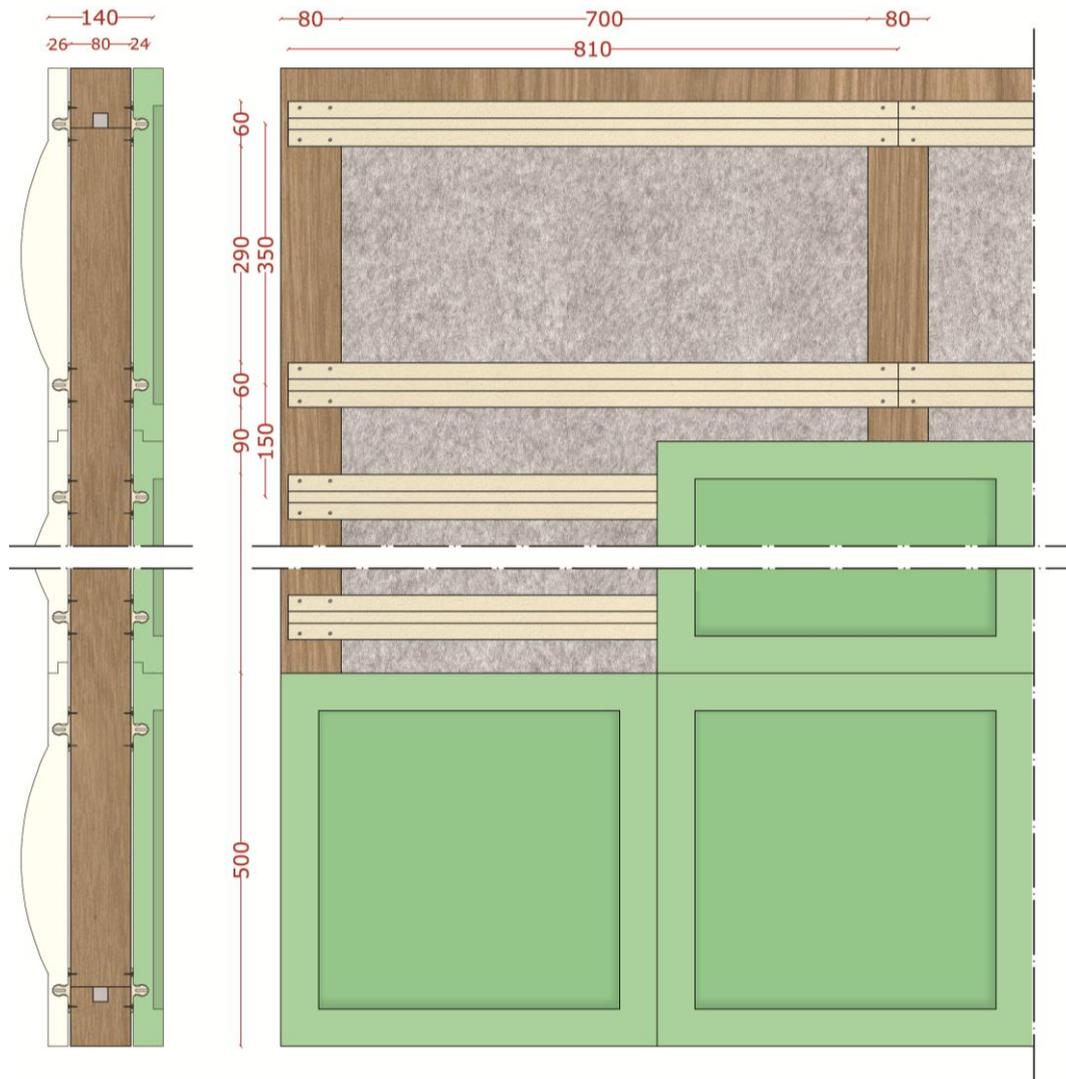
Sezione e prospetto del sistema parete. Le misure sono espresse in millimetri.
